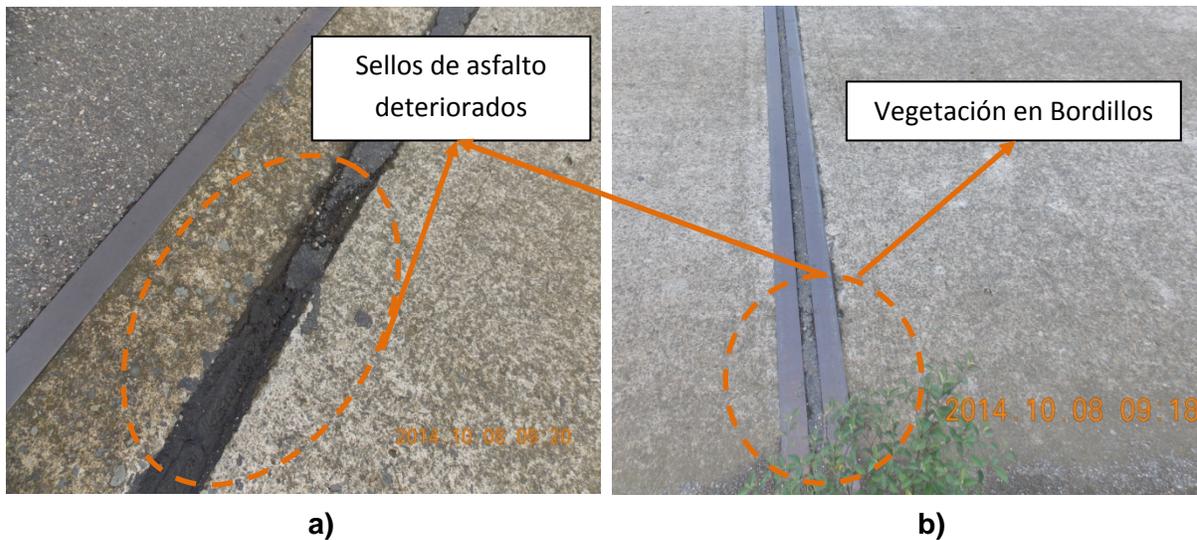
Detalles de juntas expansión: a) juntas en bastión; b) juntas en pilas.
